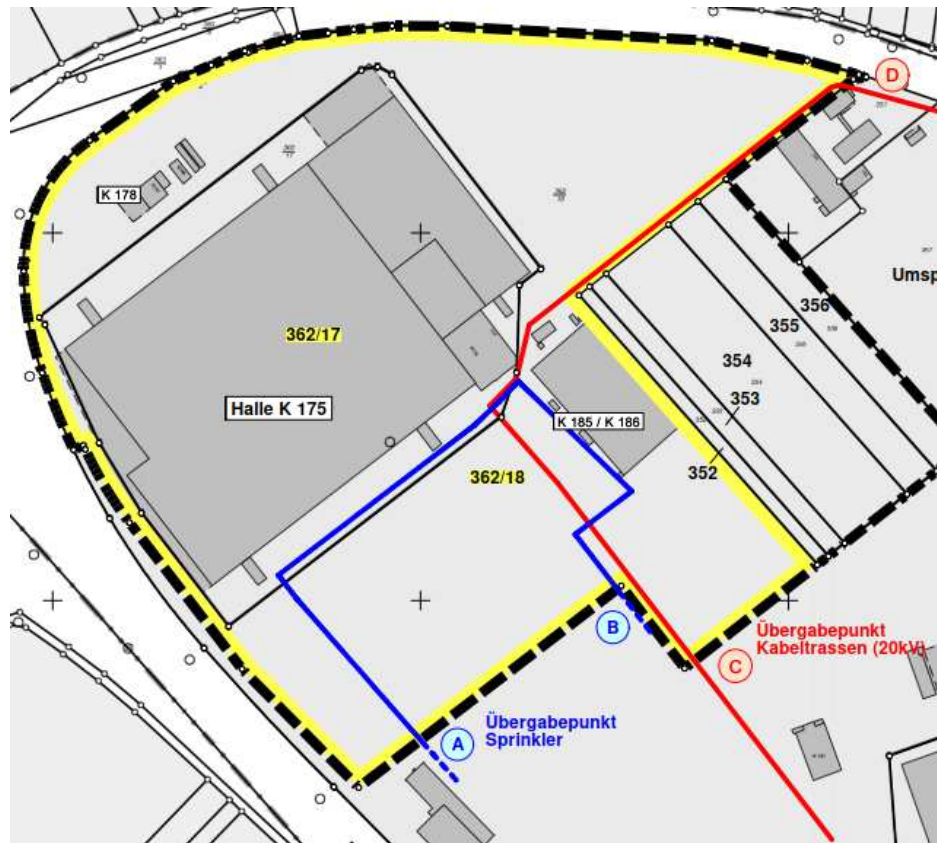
Lageplanausschnitt - bestehende Leitungstrassen für OPEL (vgl. Anhang A-03)
